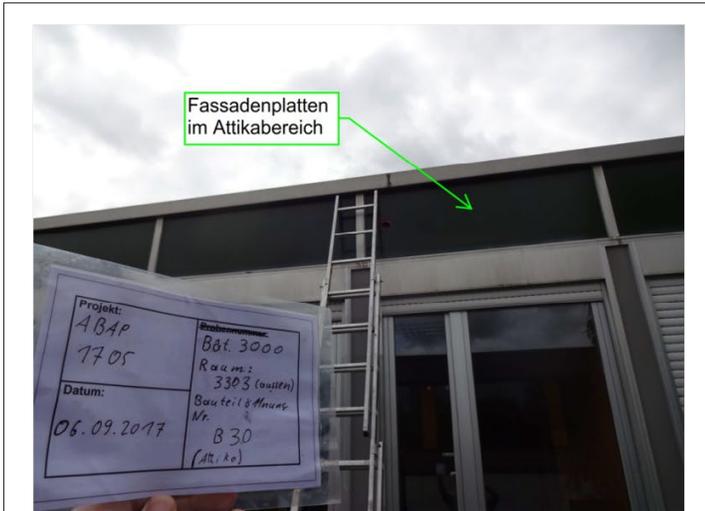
+11: Beispiel Foto für die Öffnung einer Fassadenplatte im Attikabereich
